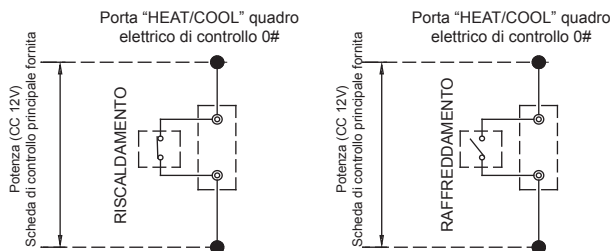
Cablaggio porta elettrica debole "HEAT/COOL"
